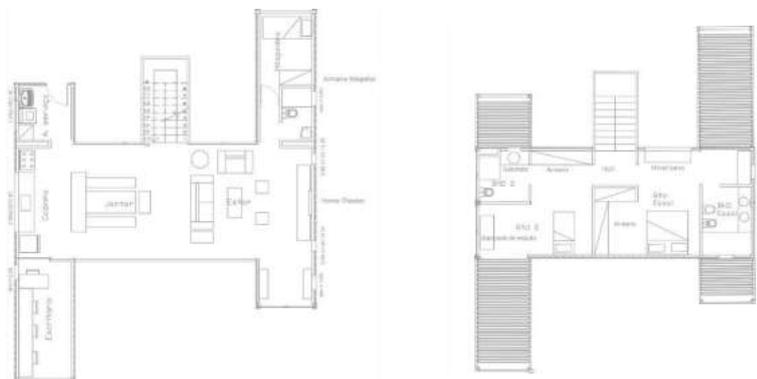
e 22: Plantas baixa. Fonte: ArchDaily, 2016.
